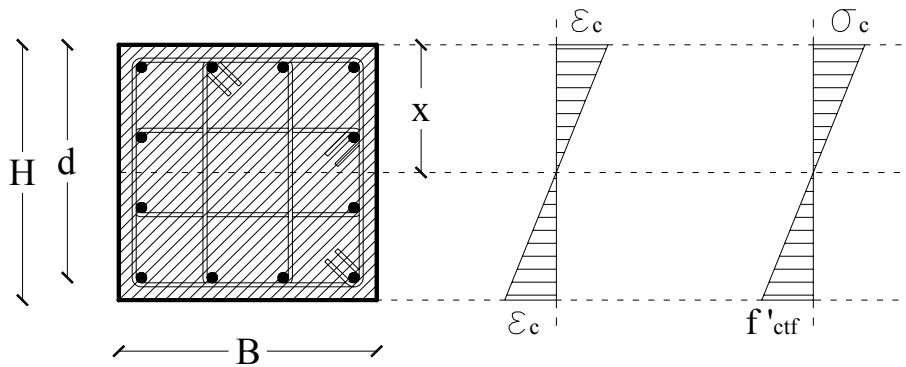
Limite di prima fessurazione per la sezione trasversale dei pilastri.
